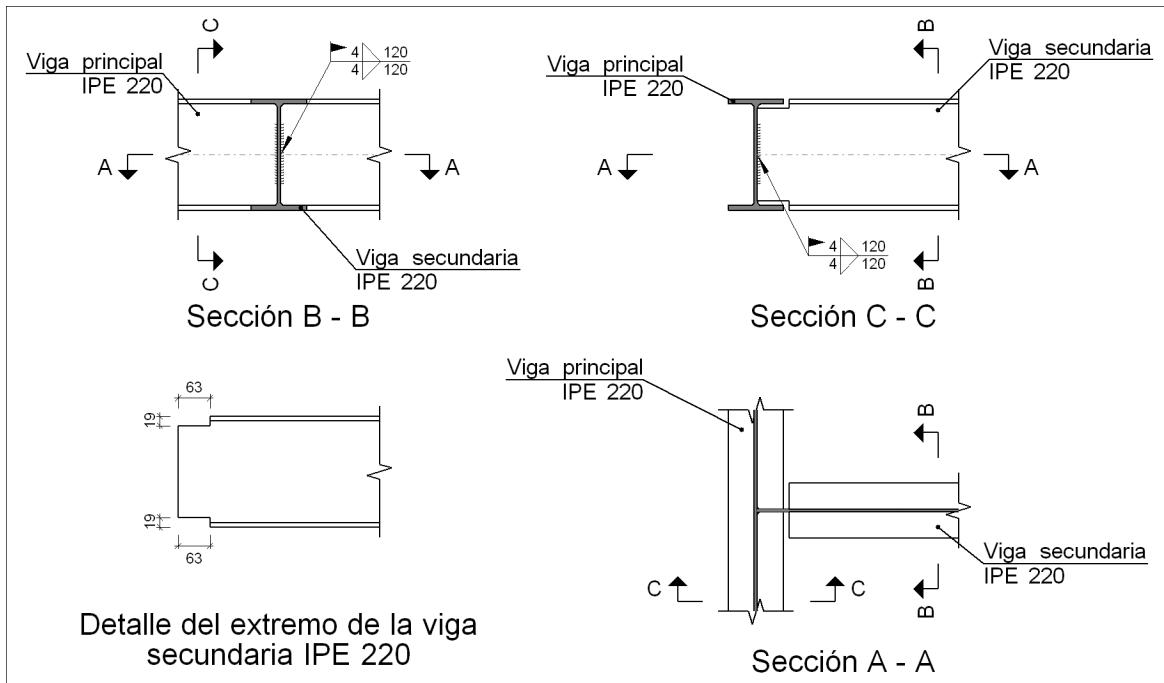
Detalle de las soldaduras tipo 4 del soporte superior
